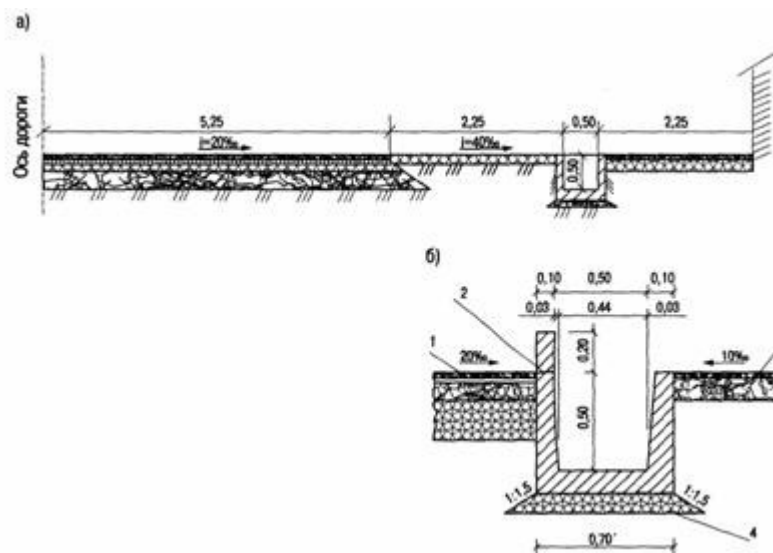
Система организации поверхностного водоотвода на автомобильной дороге Кундуз - Файзабад (Афганистан) с водосбросными лотками: а - прямоугольного поперечного сечения; б – трапецидального поперечного сечения; 1 - проезжая часть; 2 - прорези по 20 см через 1 м; 3 - тротуар; 4 - основание из гравийного материала
